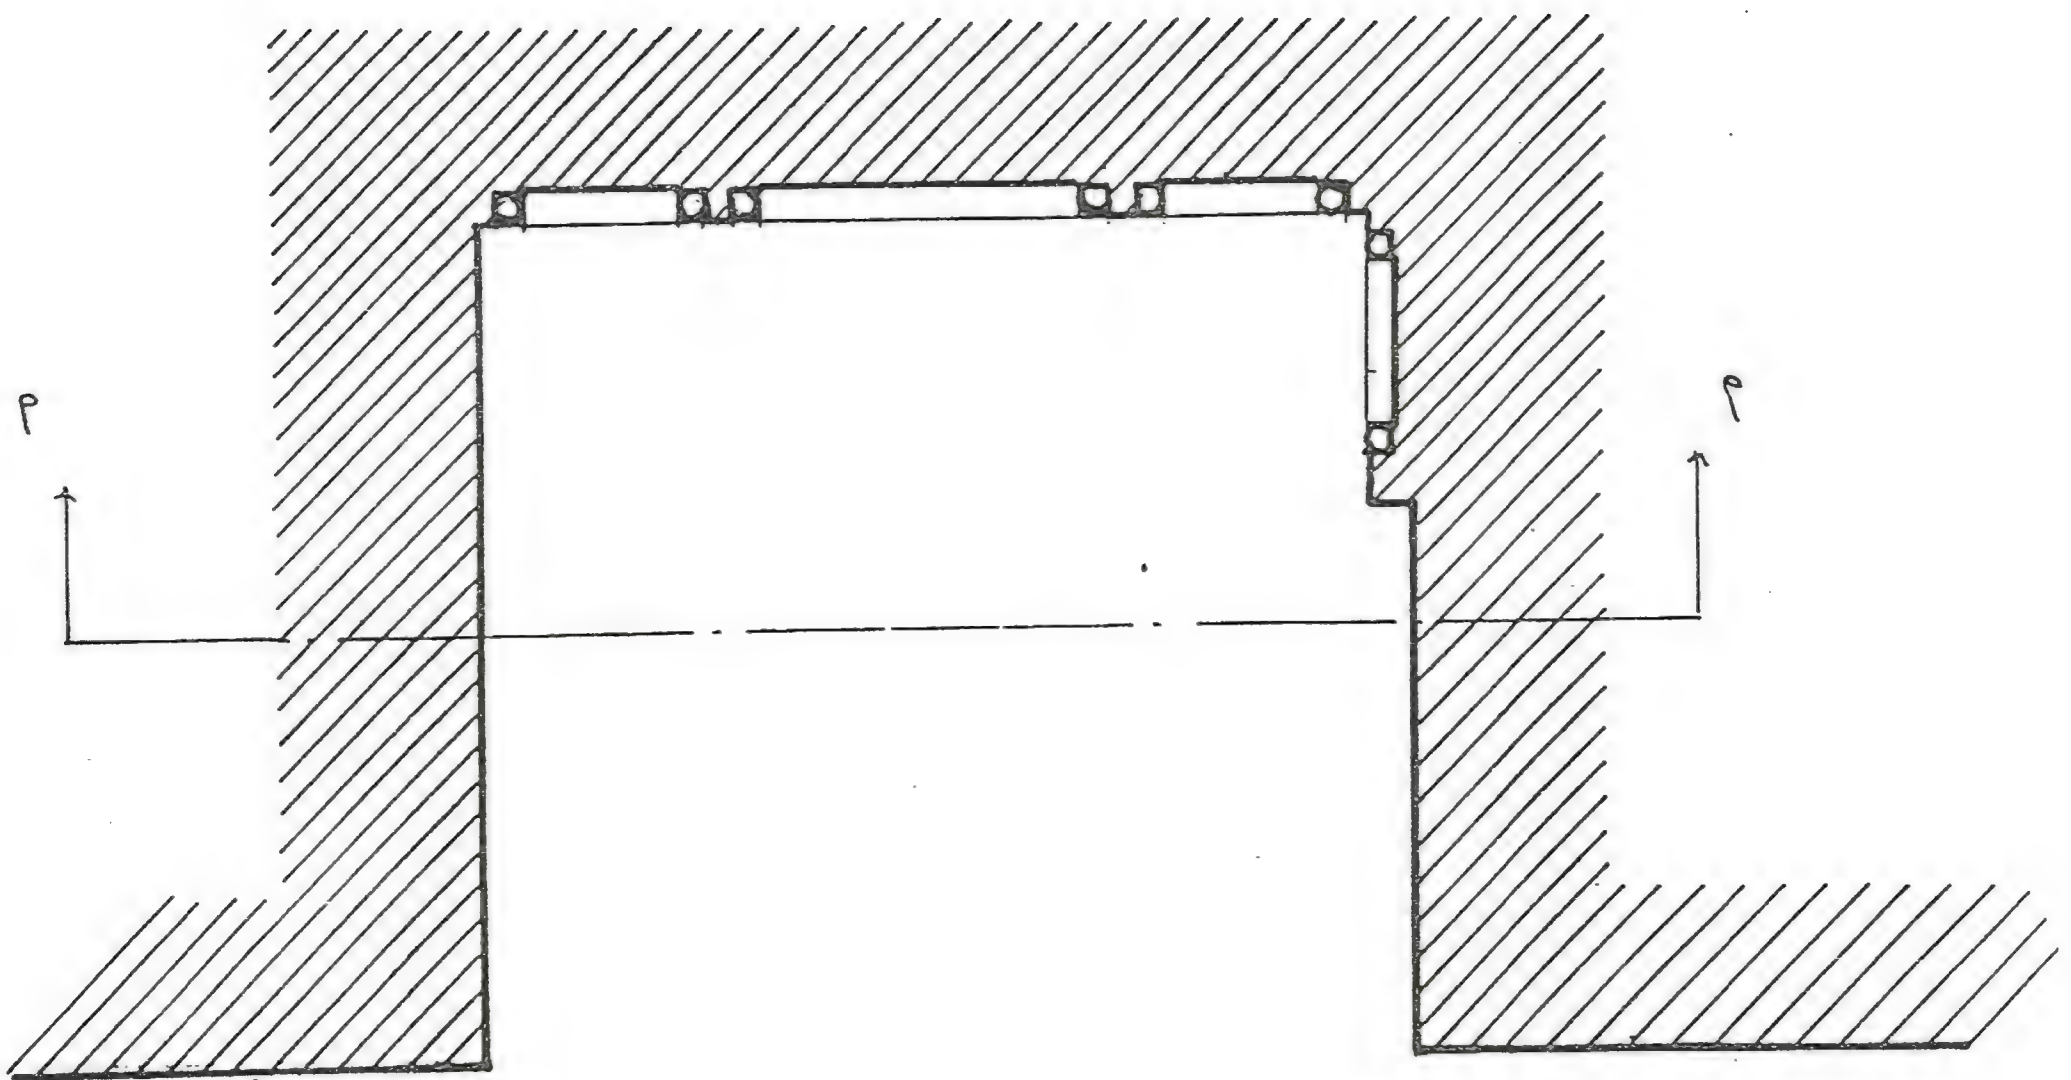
مسقط أفقى لحوض مدرسة أم السلطان شعبان
